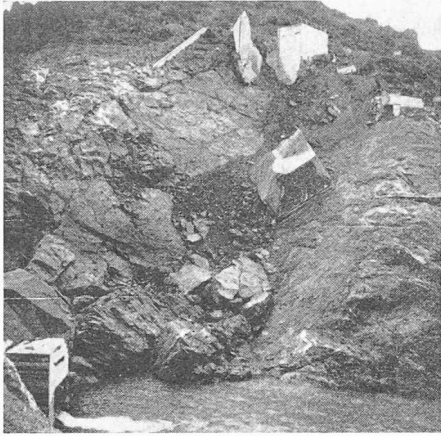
Einzelheiten des linken Widerlagers und des linken Hanges. Am abgestürzten Blöcke sind fest mit dem Beton verbundene Felsteile erkennbar
